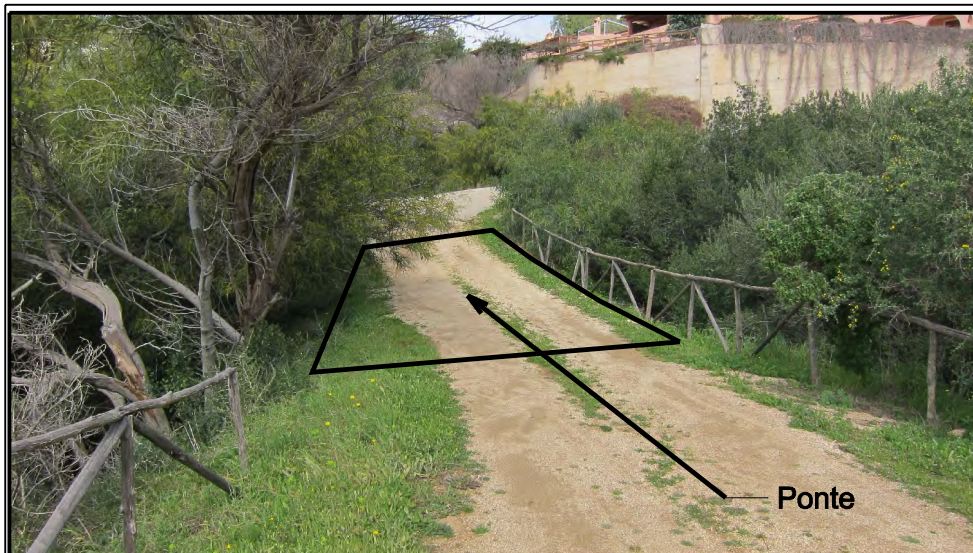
Bacino Ponte 1 - particolare Ponte a monte
